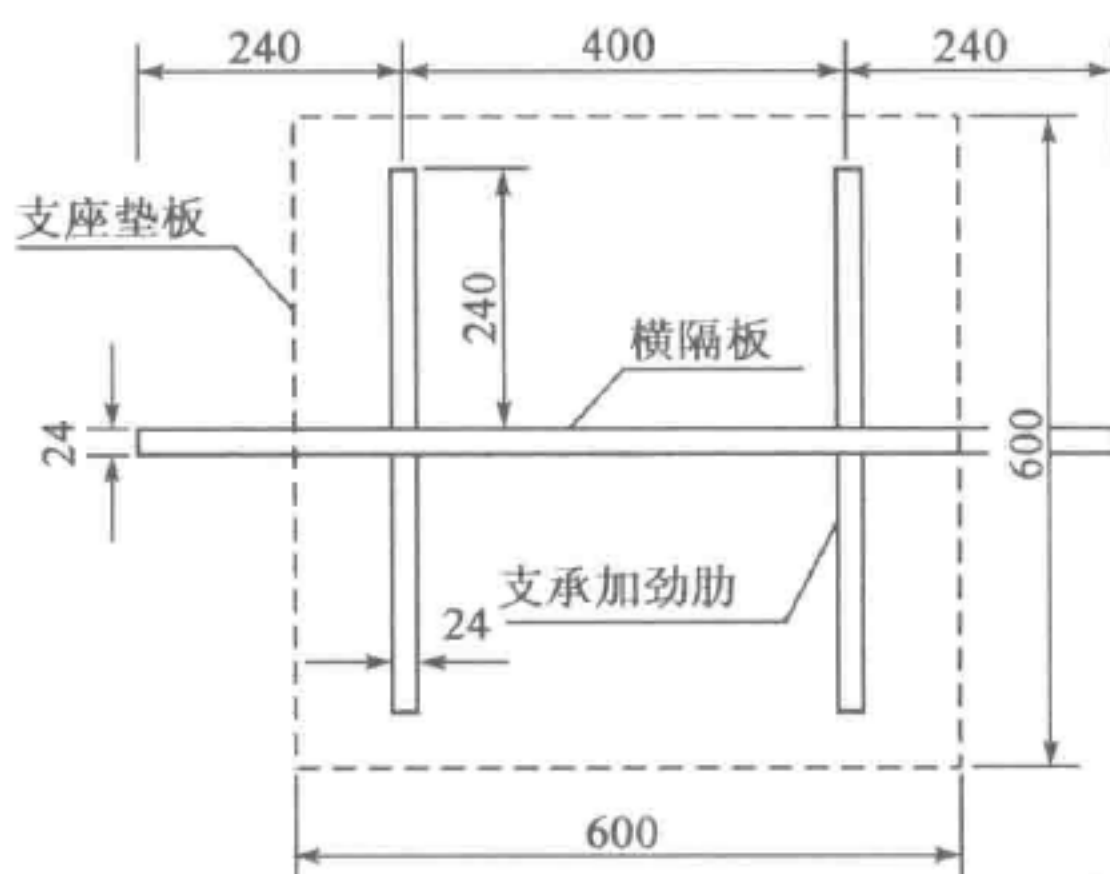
支承加劲肋平面布置示意图(尺寸单位:mm)
